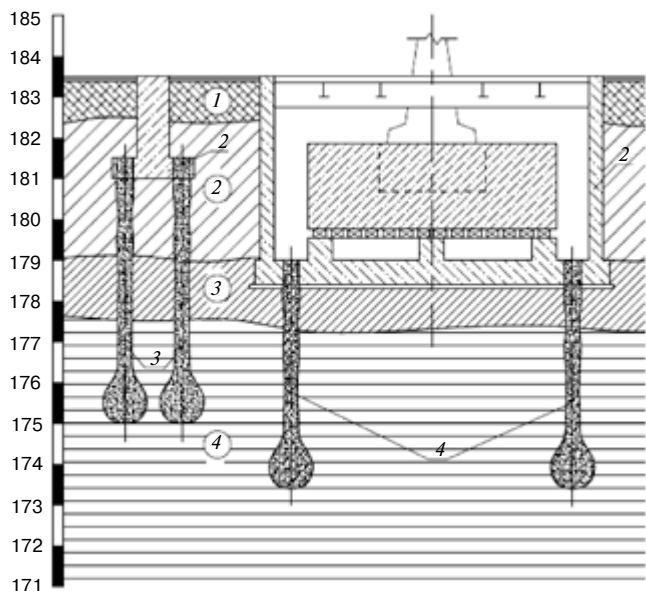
Инженерно-геологический разрез: 1 – фундамент каркаса здания; 2 – фундамент кузнечного молота; 3 – буроинъекционные сваи ЭРТ усиления основания фундаментов каркаса; 4 – буроинъекционные сваи ЭРТ усиления оснований фундаментов кузнечных молотов; ① – насыпной слой; ② – суглинок тугопластичный; ③ – суглинок мягкопластичный; ④ – глина алевролитистая тугопластичная
